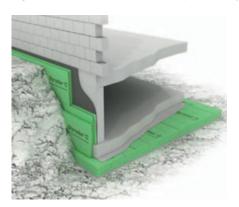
Aislamiento perimetral en muros de sótano y losa de cimentación mediante planchas de poliestireno extruido. Fuente: BASF – Styrodur
